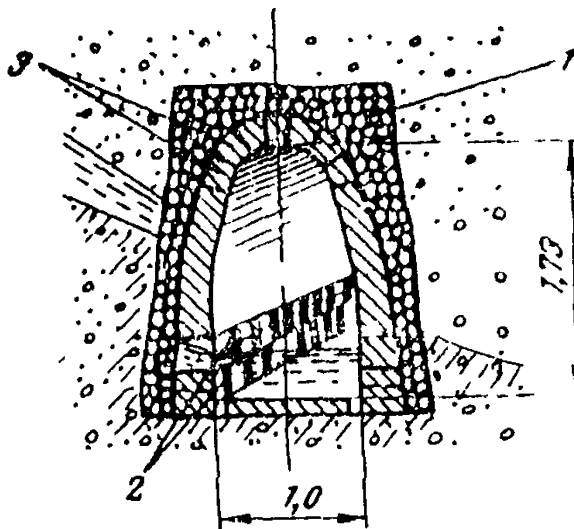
Конструкция дренажного туннеля с наружным фильтром, [Л 30]
